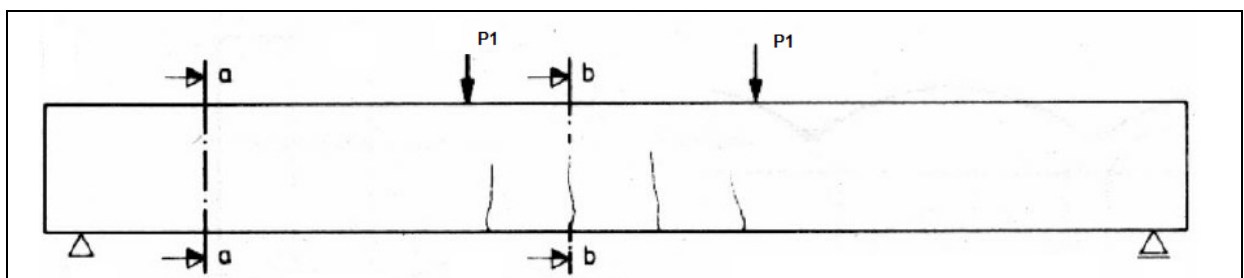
Aparecimento das primeiras fissuras (SILVA; MELO, 2005).
